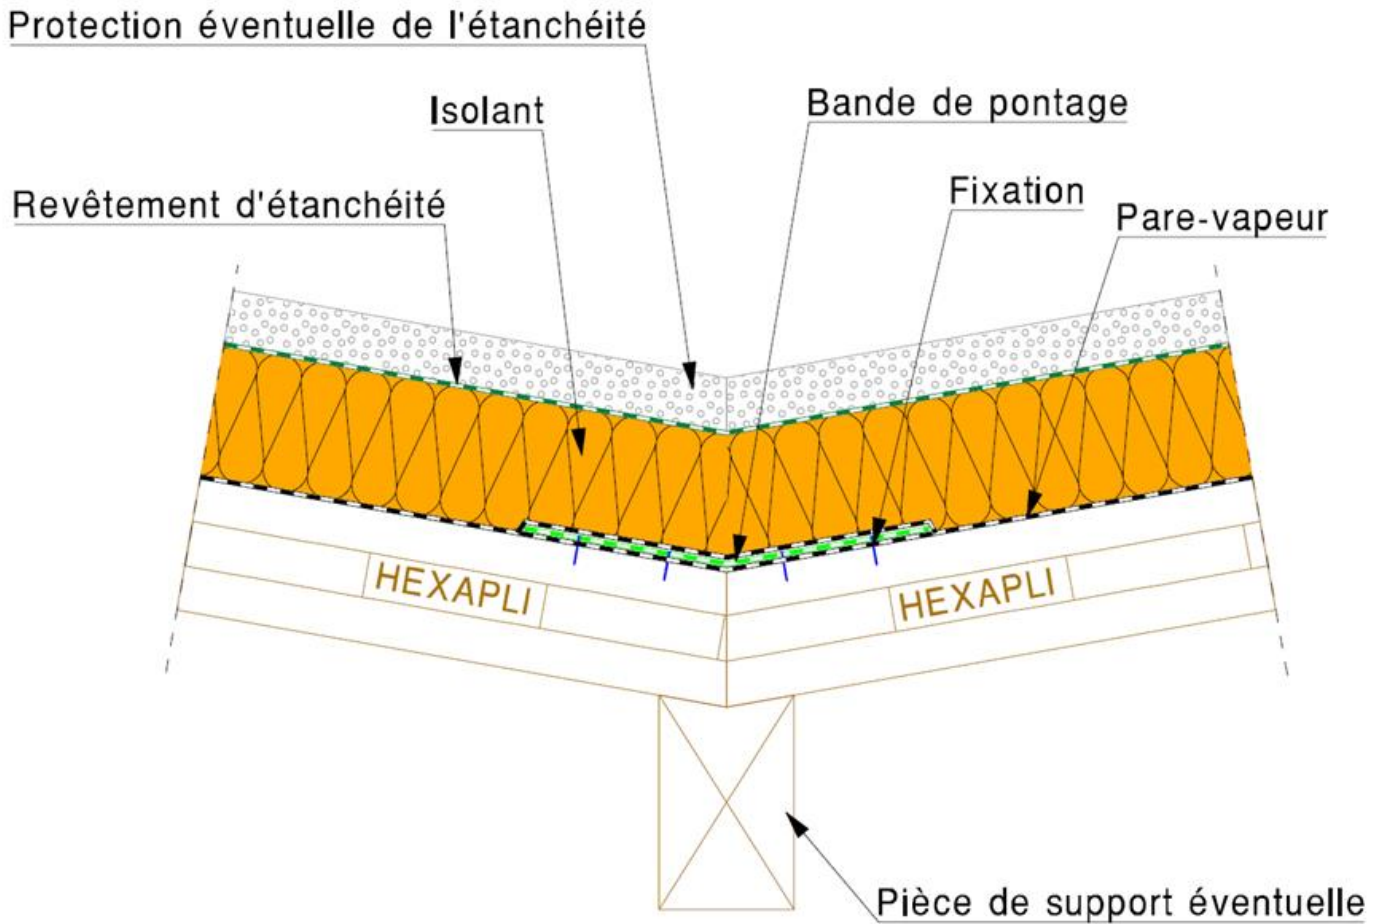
Toiture chaude isolée inaccessible - Retombée d'étanchéité
